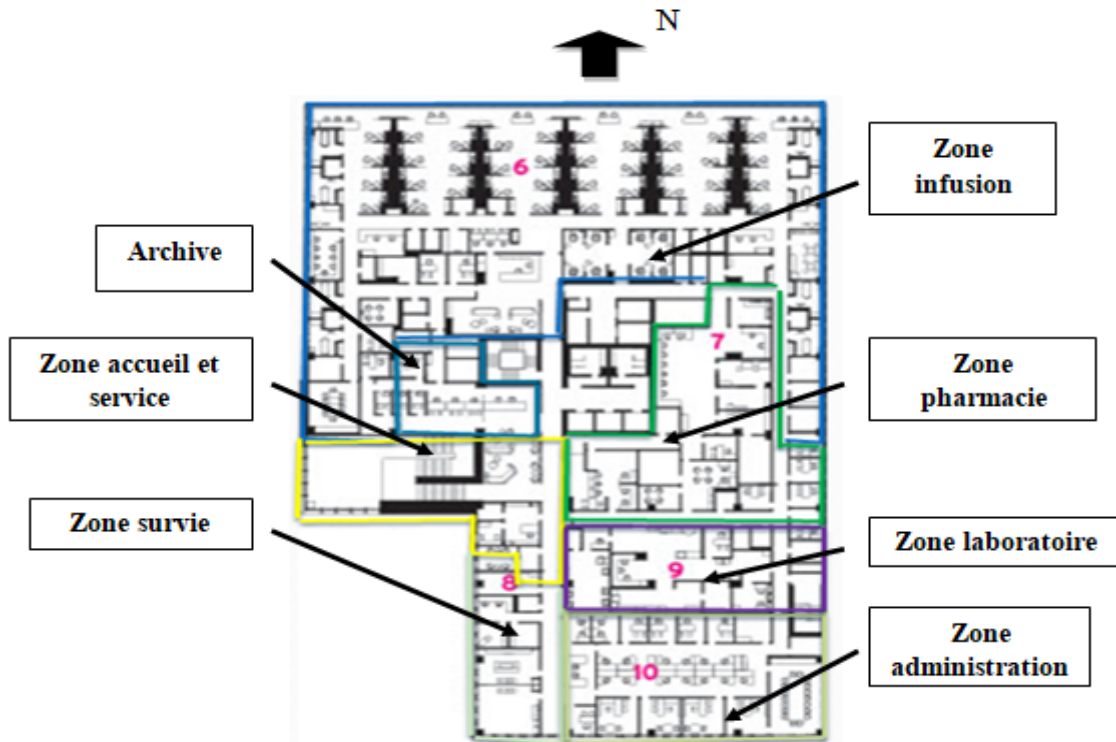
Plan 1^{ère} étage (www.archdially.com)
